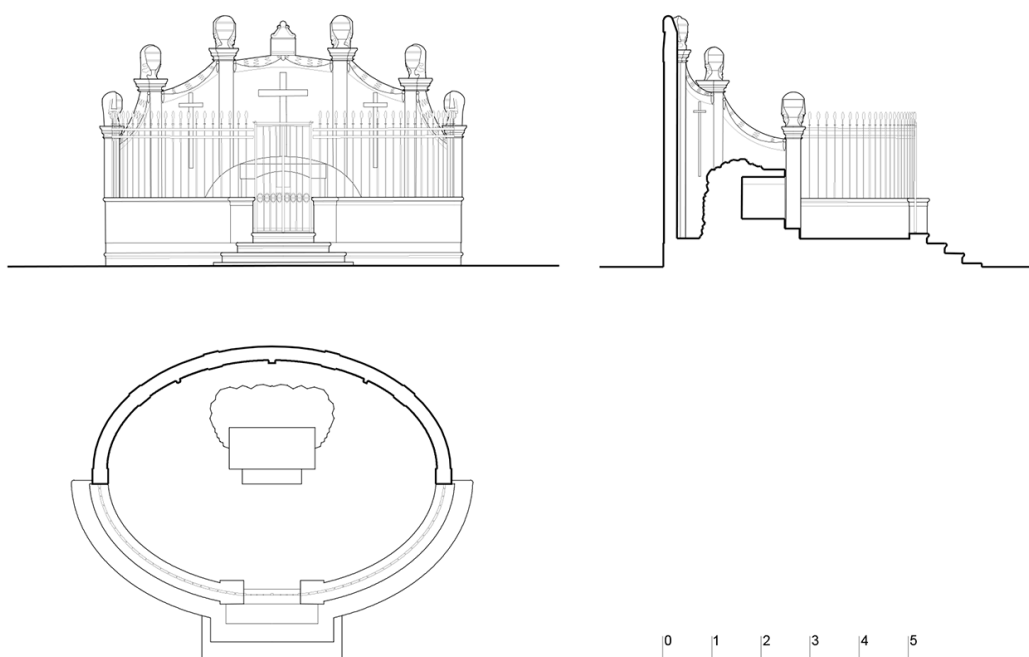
Calvario di Melpignano. Prospetto, pianta e sezione: H 5,11 m x L 7,40 m x P 6,40 m.
